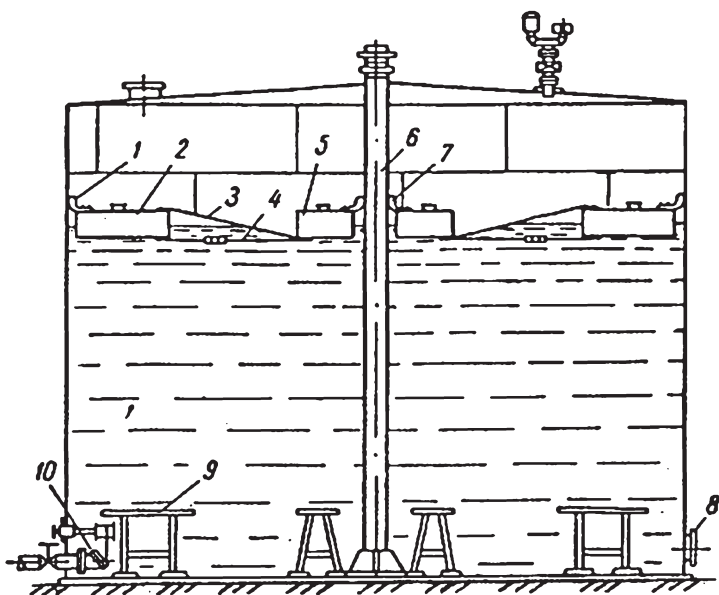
Резервуар с плавающим металлическим понтоном: 1—уплотняющий затвор; 2—периферийный короб понтона; 3—мембрана из листового металла; 4—стяжка; 5—центральный короб понтона; 6—направляющая труба; 7—уплотнение направляющей трубы; 8—люк-лаз; 9—опоры для понтона; 10—приемо-раздаточный патрубок с хлопнушкой
